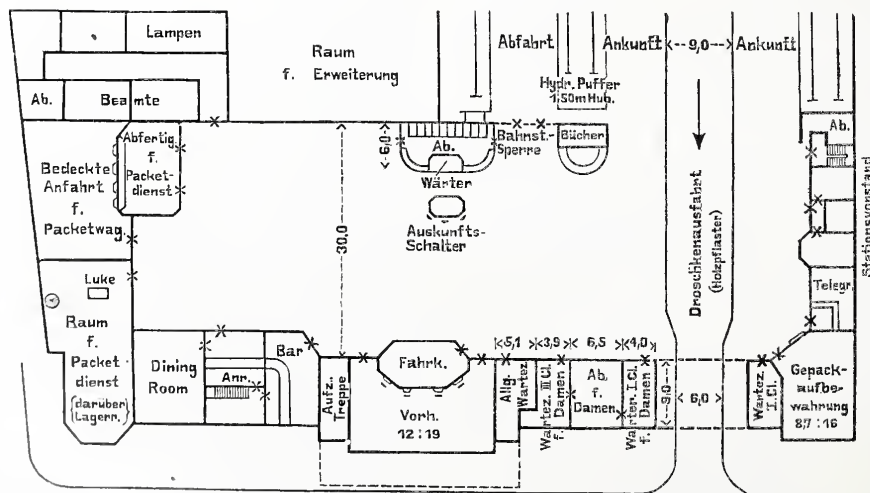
Grundriss der Station Marylebone in London (Empfangsgebäude).
